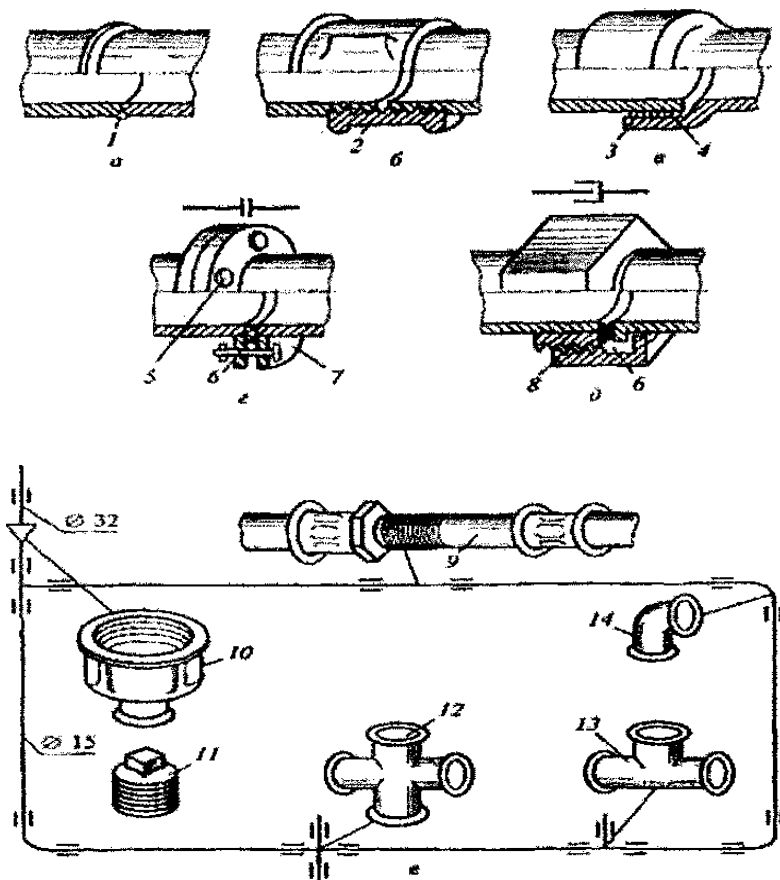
Соединение водогазопроводных труб: а - сварное в стык; б - муфтово-резьбовое; в - раструбное; г - фланцевое; д - с накидной гайкой; е - соединительные части и их условное обозначение; 1 - сварной шов; 2 - муфта; 3 - раструб; 4 - уплотнение; 5 - болт с гайкой; 6 - уплотнительная прокладка; 7 - фланец; 8 - накидная гайка; 9 - сгон; 10 - муфта переходная; 11 - пробка; 12 - крестовина; 13 - тройник; 14 - угольник
